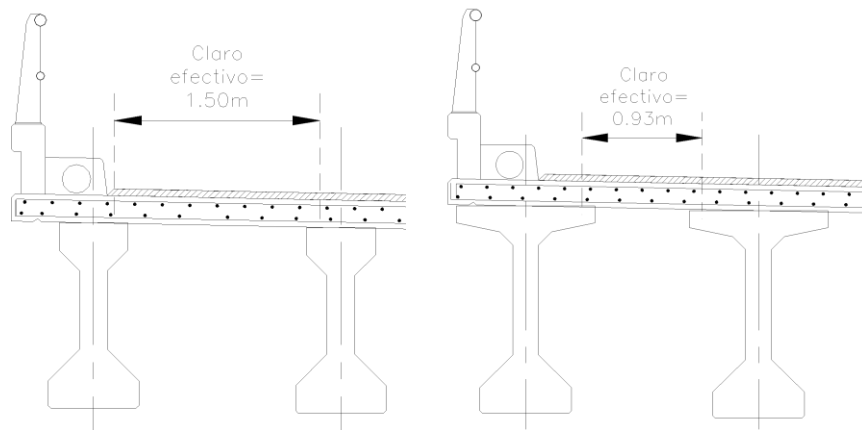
Armados para losa tipo I (lado izquierdo) y losa tipo II (lado derecho).
